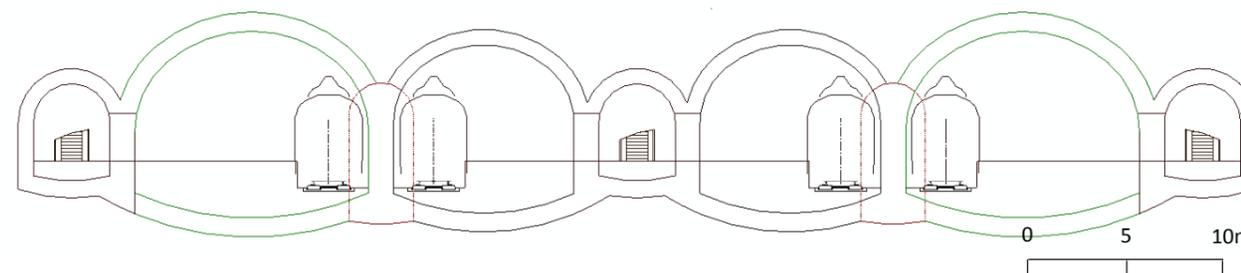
Section à 4 voûtes retenue pour la gare Lille-Flandres
